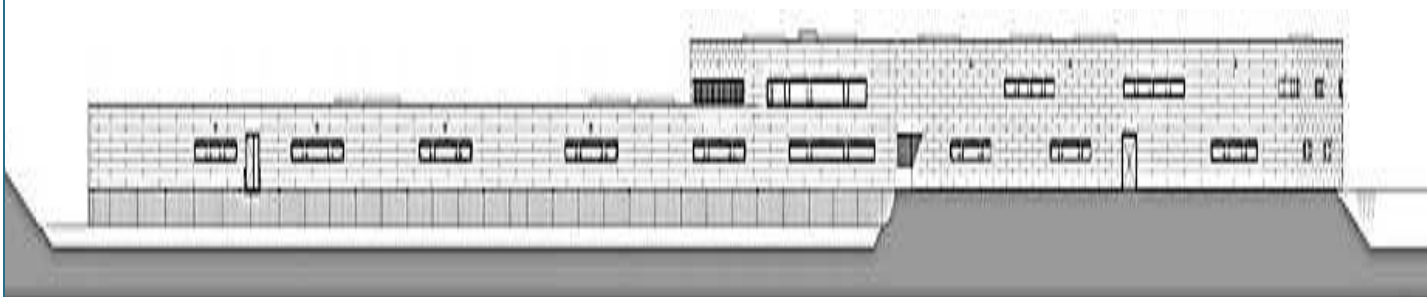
Elevación Sur del Centro Fuente: <https://www.flickr.com/photos/>
